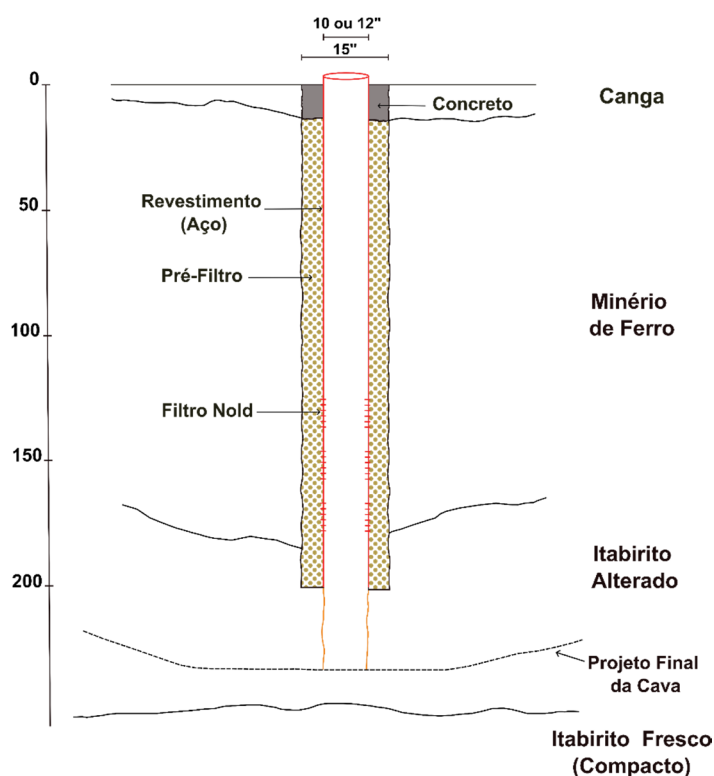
Exemplo de projeto construtivo do poço para rebaixamento da zona saturada e viabilização da extração do minério.
